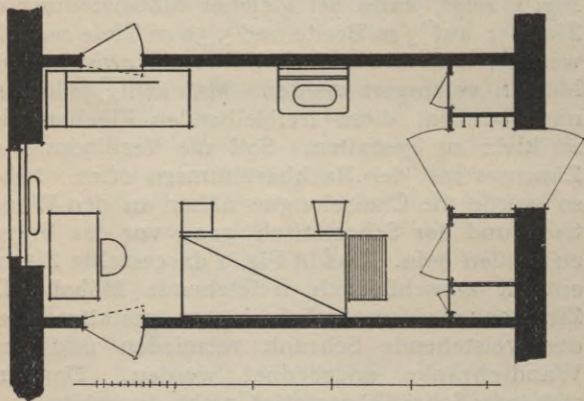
Das Zimmer mit einem Bett und Wandschränken.
